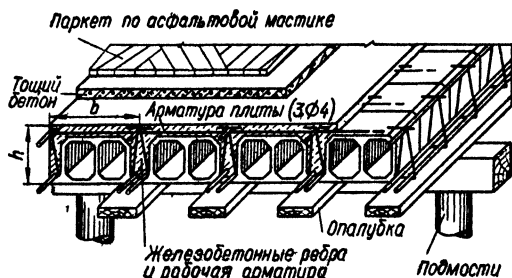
Часторебристое перекрытие в монолитном железобетоне.
